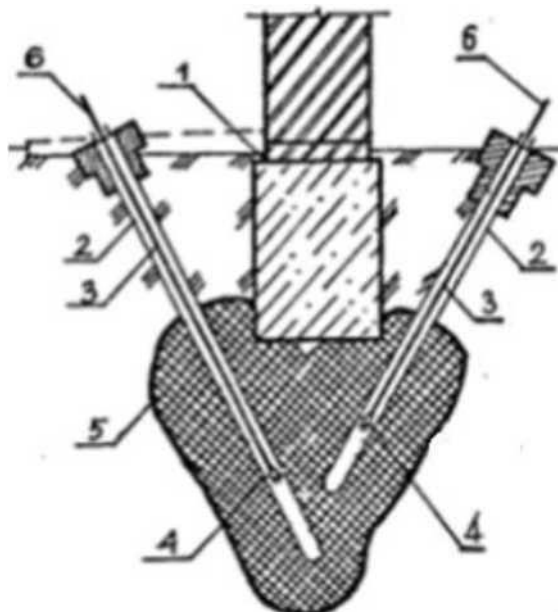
Термическое закрепление грунтов: 1-существующий фундамент; 2- скважины; 3- форсунка с наконечником; 4- пламя; 5- закрепленный грунт; 6- направляющая трубка для подачи топлива.
